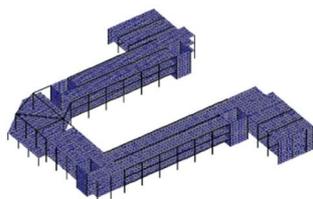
Расчетная схема здания с сеткой конечных элементов
